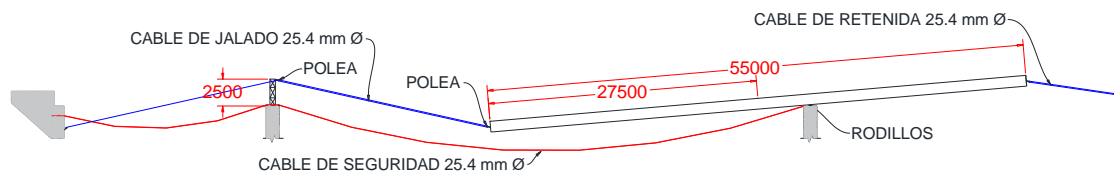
Colocación de cables de retenida cuando la viga vuela más del 50%.
